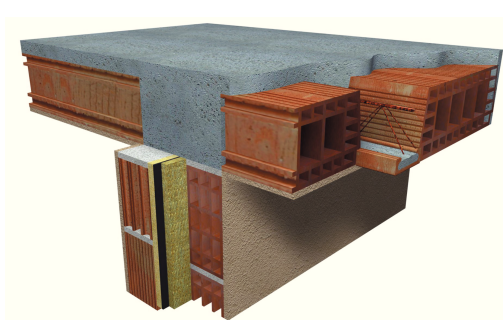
esempio di corretta progettazione del giunto parete divisoria – solaio (con trave rompitratta) [43]
